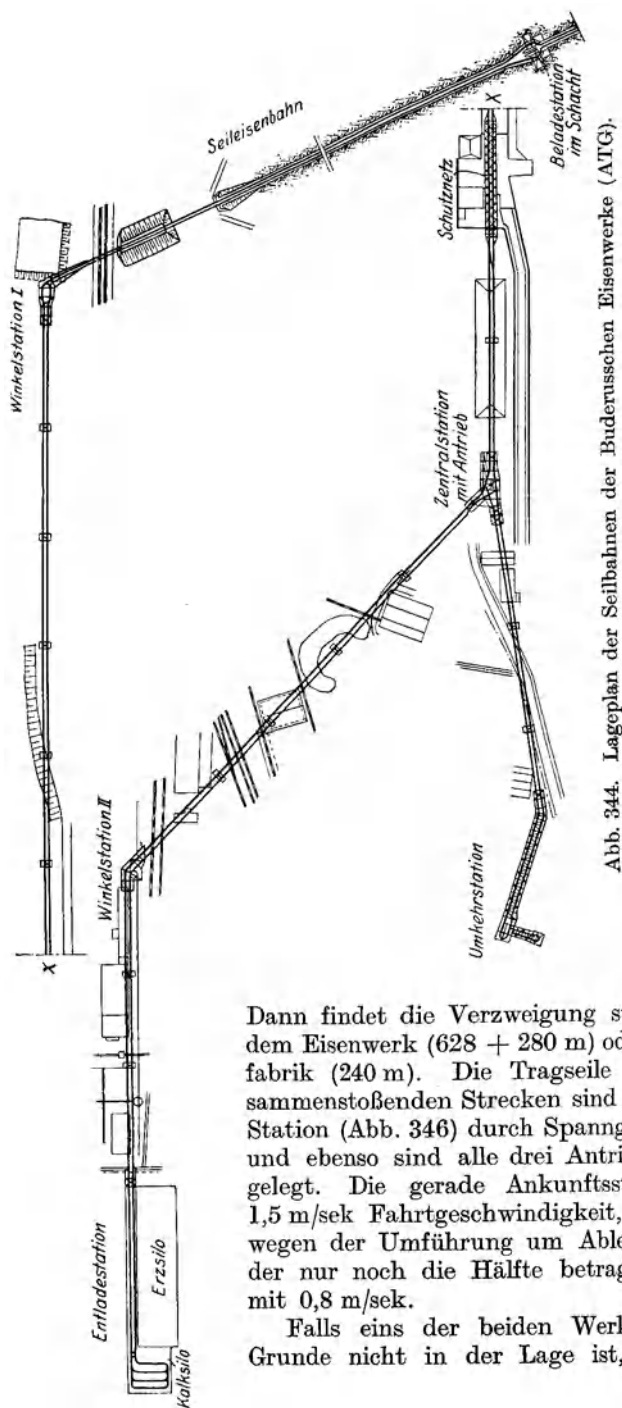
Lageplan der Seilbahnen der Buderusschen Eisenwerke (ATG).
